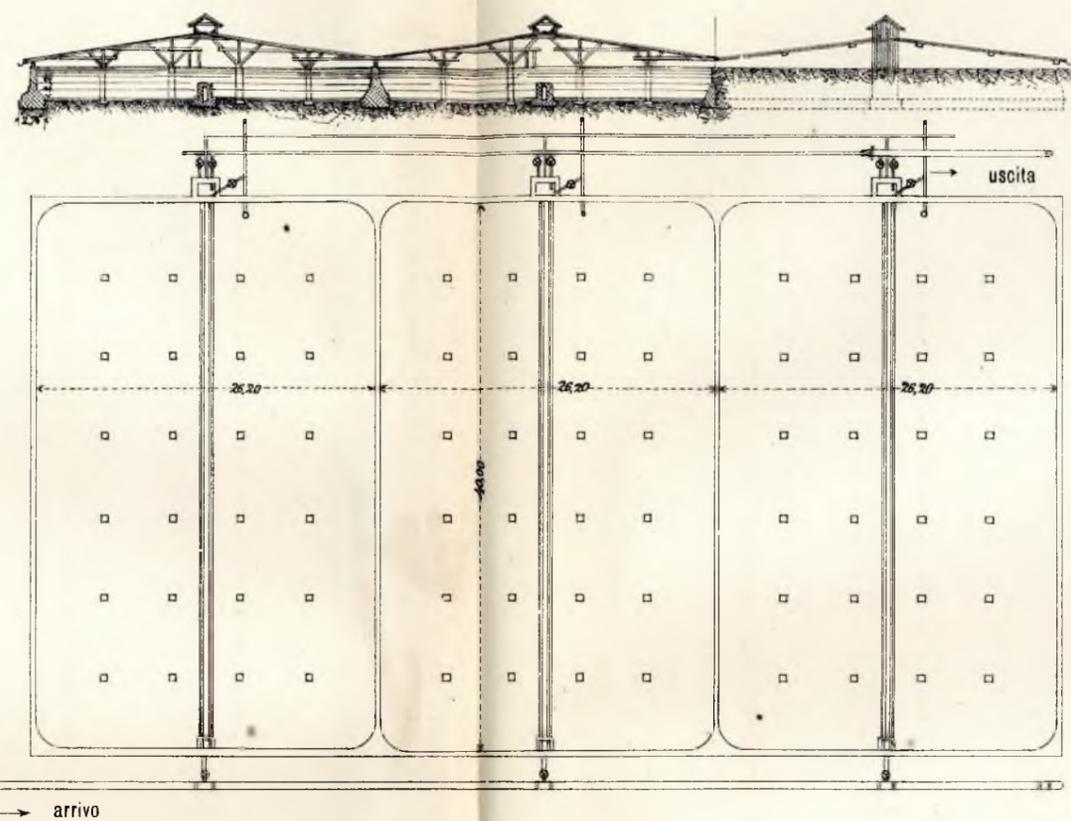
e 8. — Pianta e sezione del serbatoio in Scutari.
